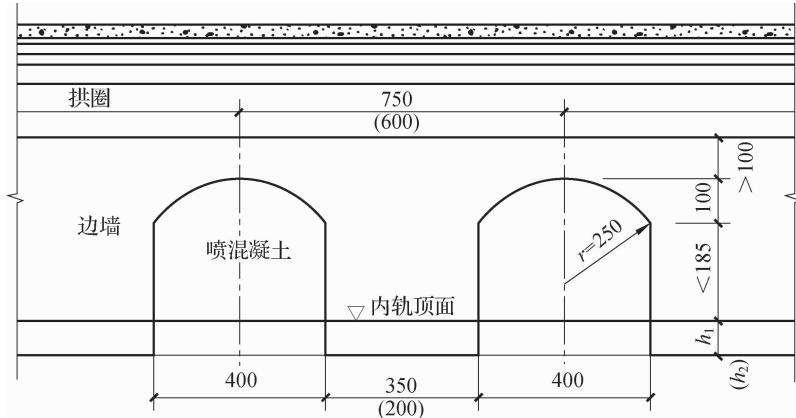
带花边墙隧道纵断面示意图(单位:cm)
